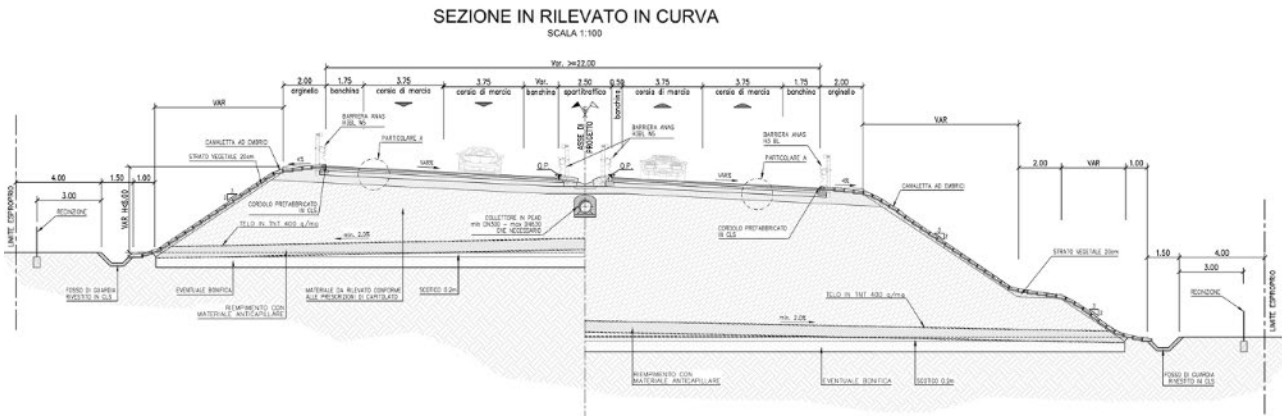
Sezione tipo in rilevato dell’asse principale con banche intermedie laterali
